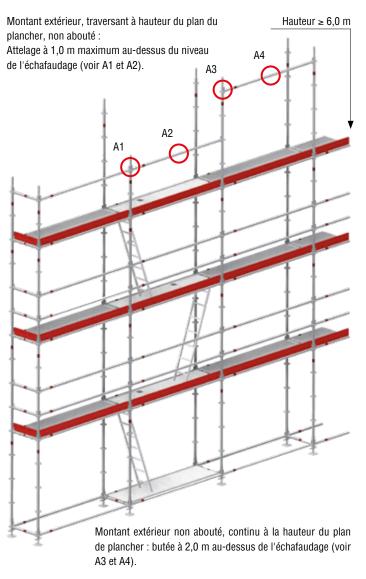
Points d'ancrage admissibles pour l'équipement de protection individuelle contre les chutes dans les montants verticaux et la lisse de garde-corps à H = 1,0 m et 2,0 m au-dessus du niveau du plancher à partir d'une hauteur ≥ 6,0 m pour les montants non aboutés à hauteur du niveau du plancher
